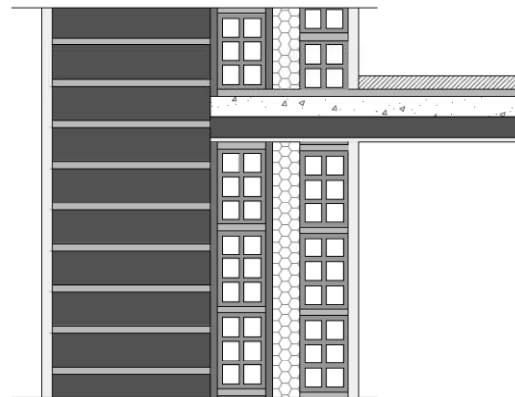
Fachada-Forjado (por revoltón). Zona oeste. Estado rehabilitado.
